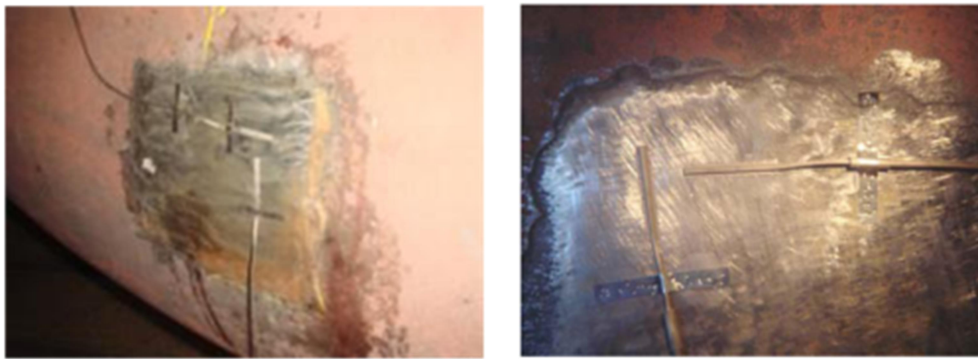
Extensômetros soldados à tubulação.
